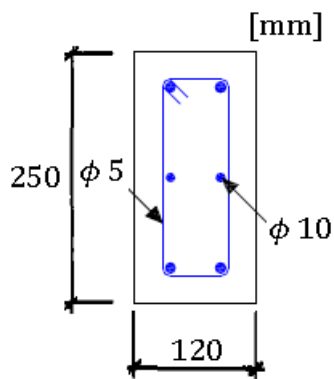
Seção transversal dos pilares de Melo (2009)
